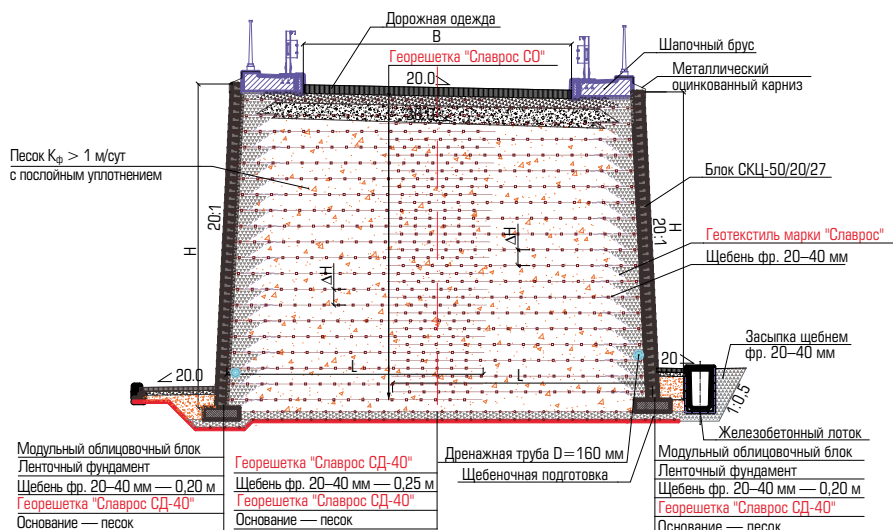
Армогрунтовая система с облицовкой модульными бетонными блоками СКЦ
